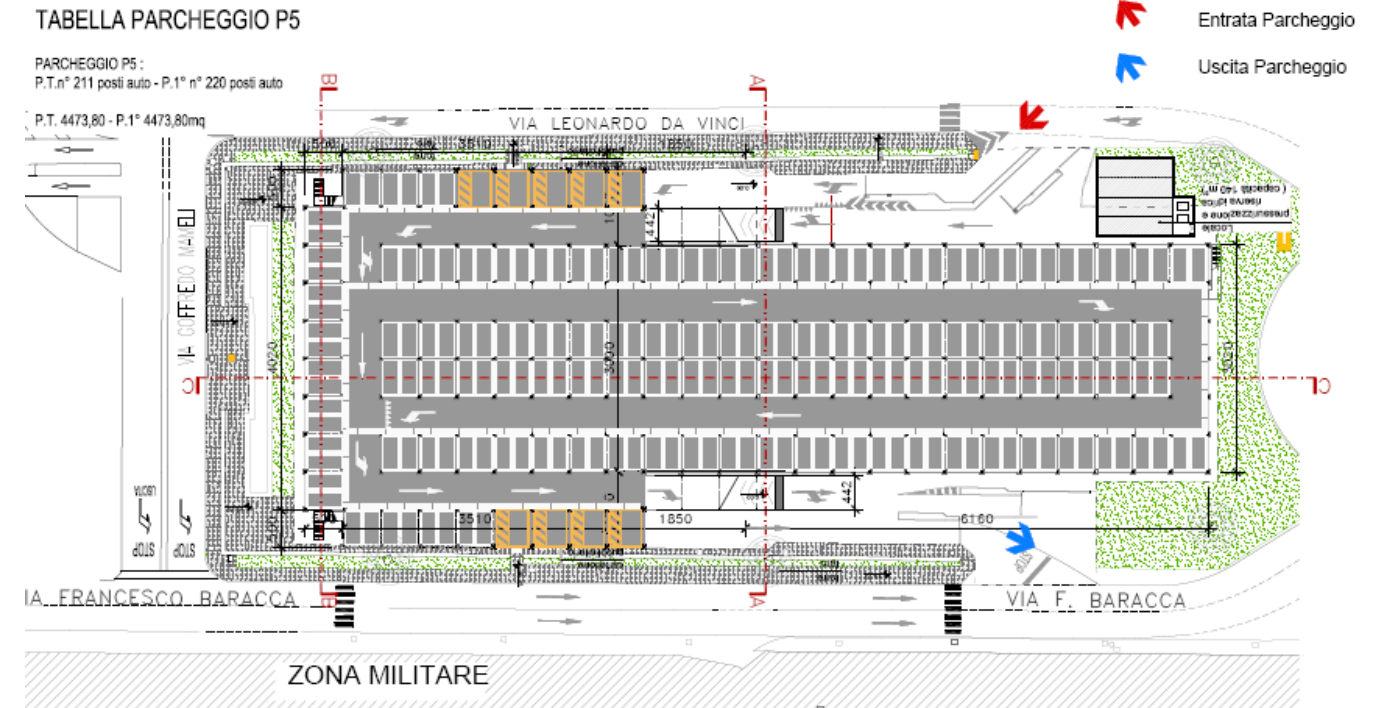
parcheggio multipiano modulare tipo fast park P5: planimetria
